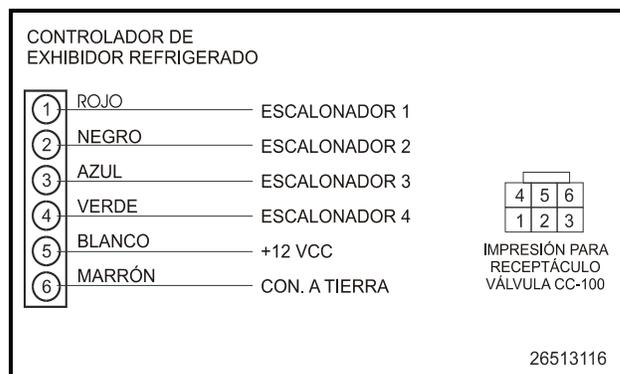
Cableado de la Válvula Escalonadora Genérica 335-3260
